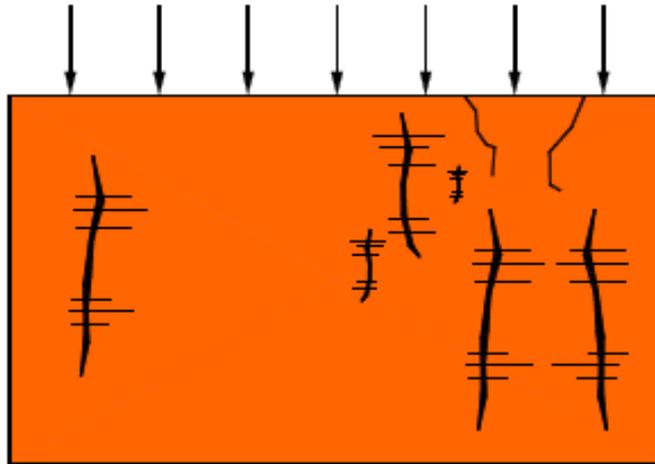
Fissuração típica da alvenaria causada pela atuação excessiva de cargas.
